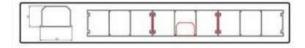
Esquema em planta do perfil canaleta dentro do módulo básico
